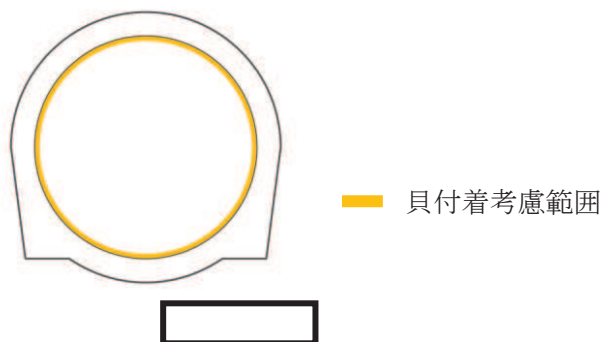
(4) 第 1 号機放水路 ①'-①' 断面図
